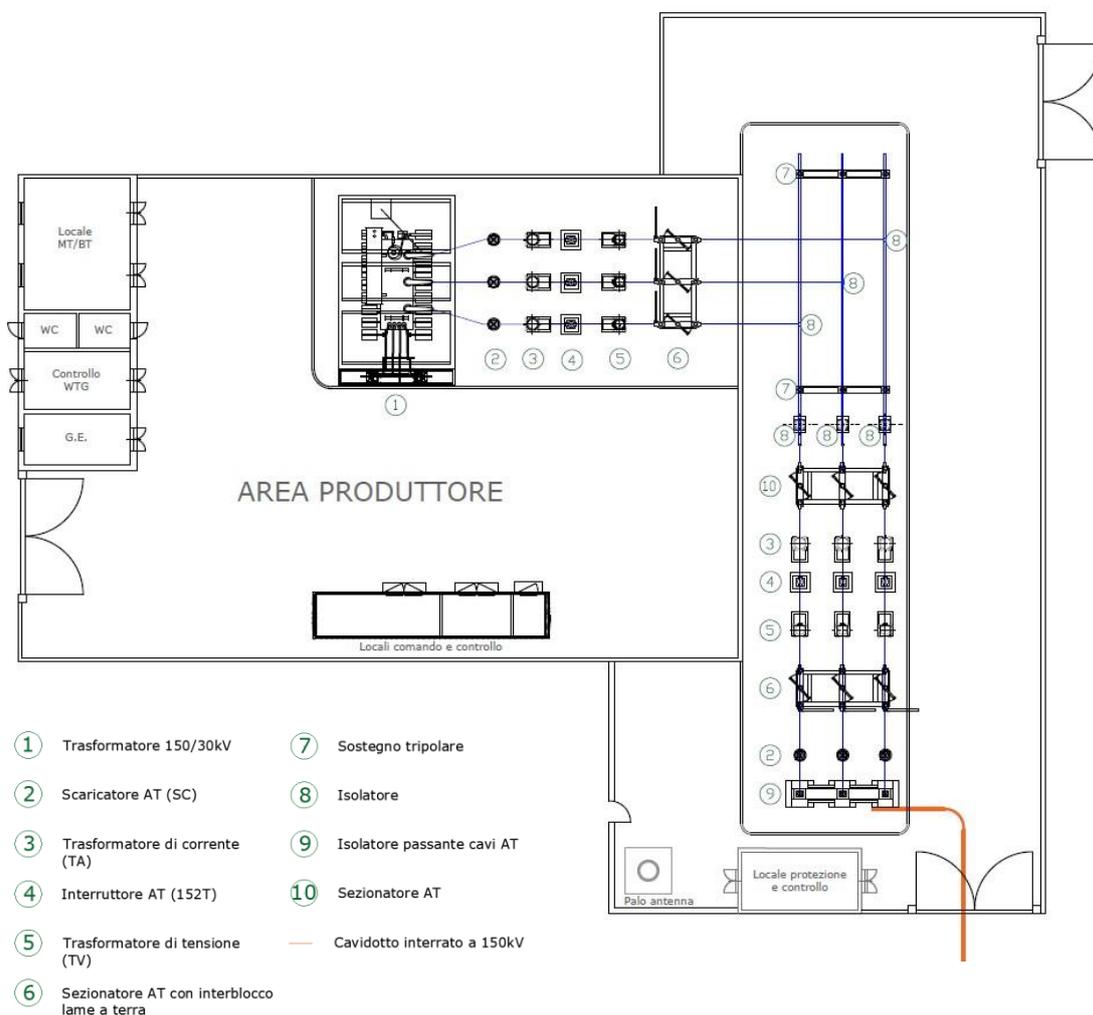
Planimetria della SSE utente di trasformazione 150/30 kV
